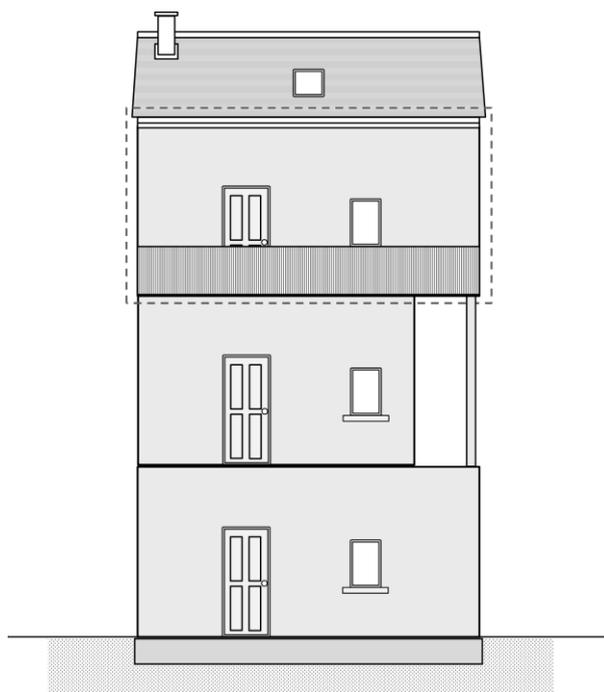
exemple de l'avancée de plancher supérieur soutenu par un poteau (proscrite)
